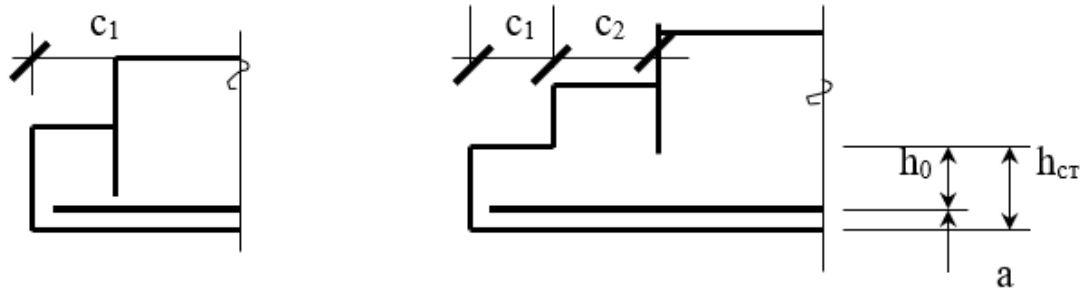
Розрахункова схема для визначення кількості арматури
